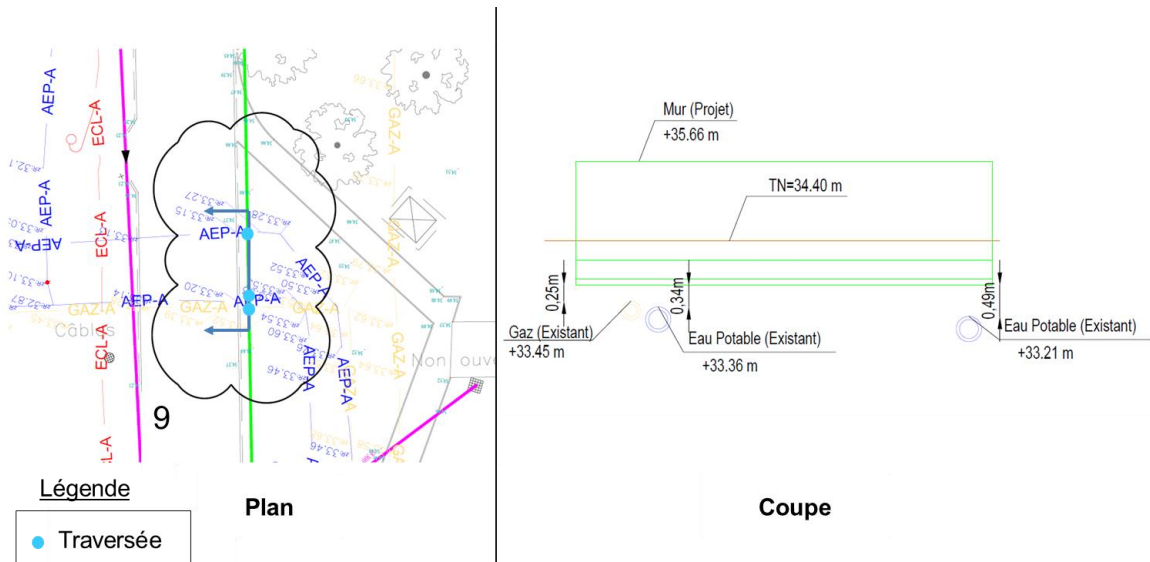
Mur traversant une conduite de gaz et deux conduites d'eau potable
